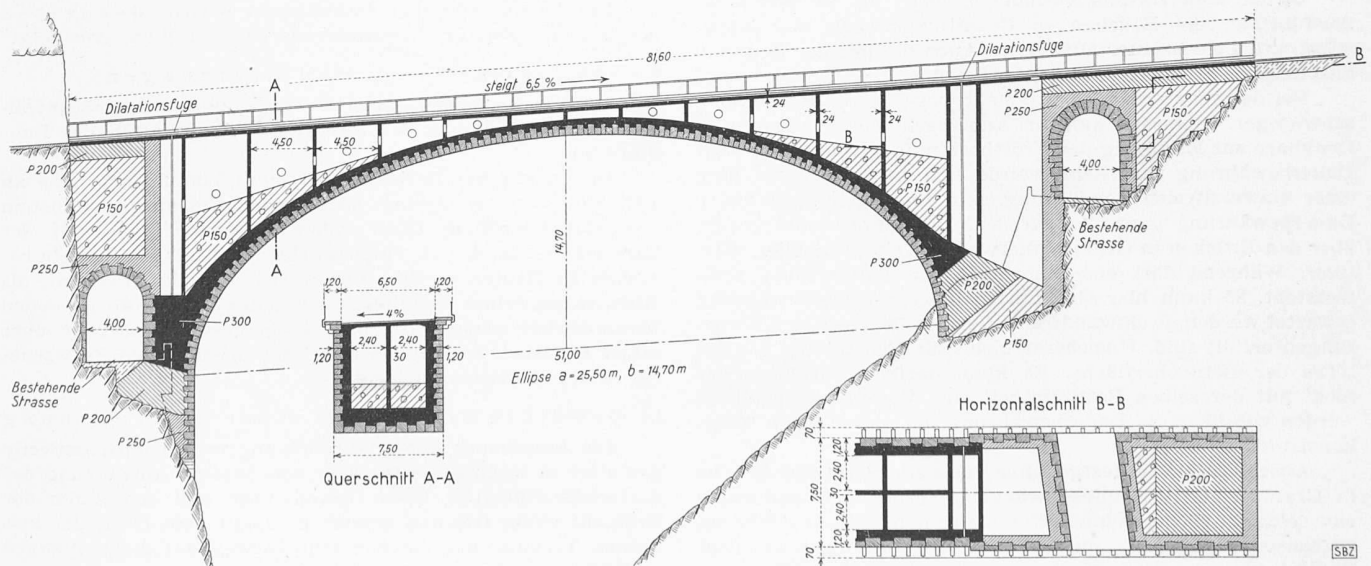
Brücke mit einer Hauptöffnung elliptischer Form in Granitmauerwerk. Längsschnitt 1:500
